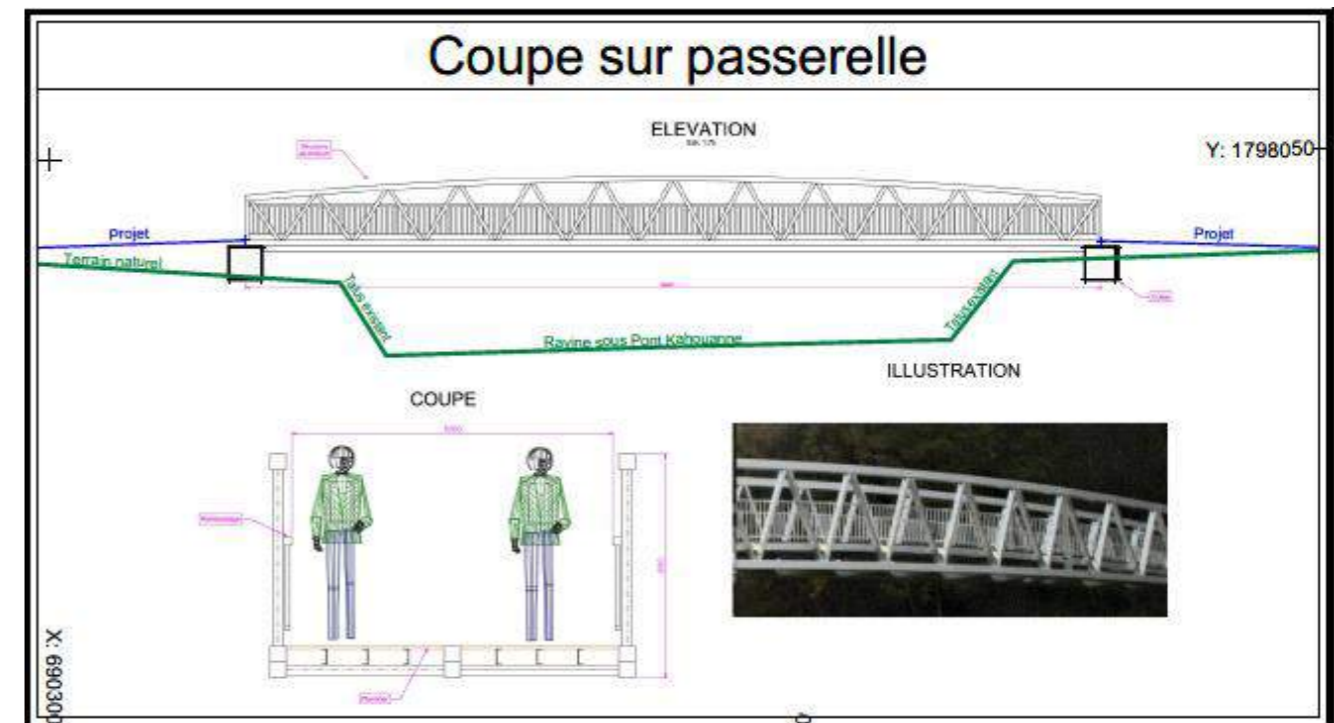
COUPE DE LA PASSERELLE ENVISAGE – PONT KAHOUANNE – PR 7+590
